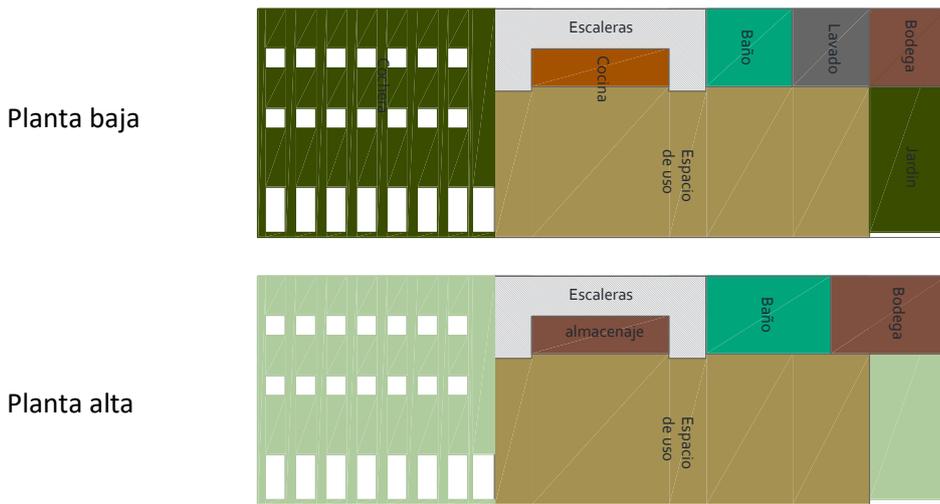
Alcántar. A. 2009. Vista Planta. Plano. Elaboración Propia
